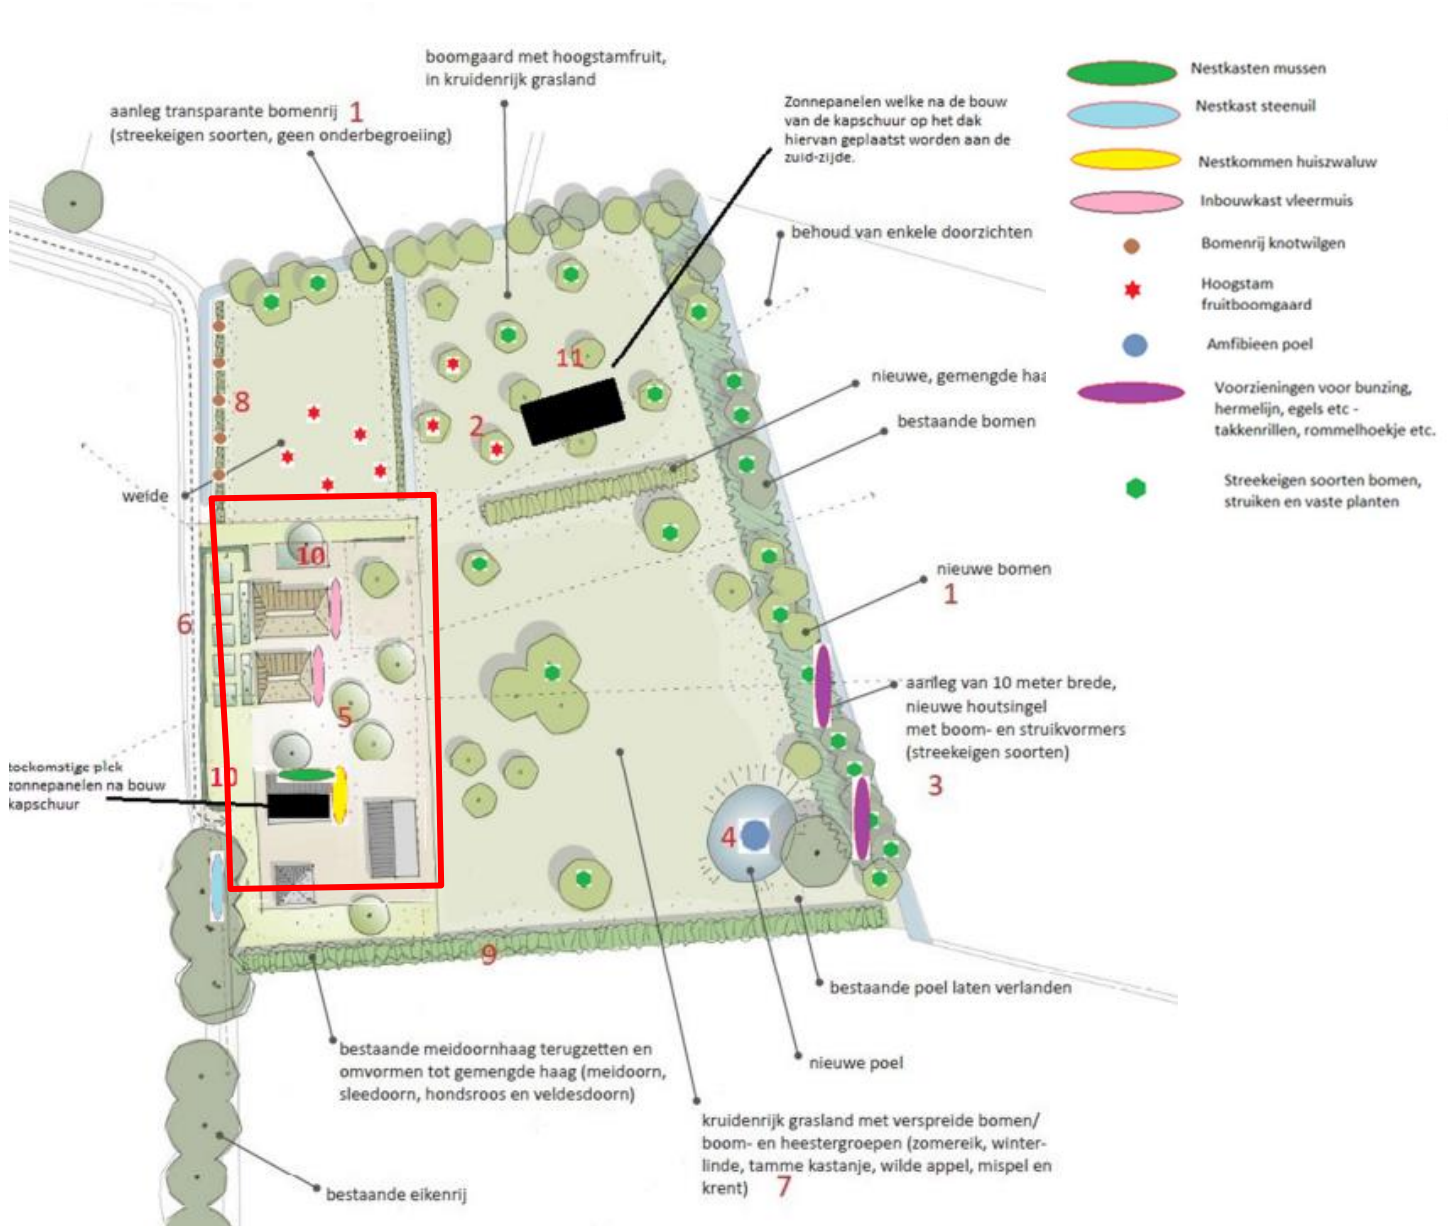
Uitsnede landschapsplan toekomstige situatie erf plangebied
